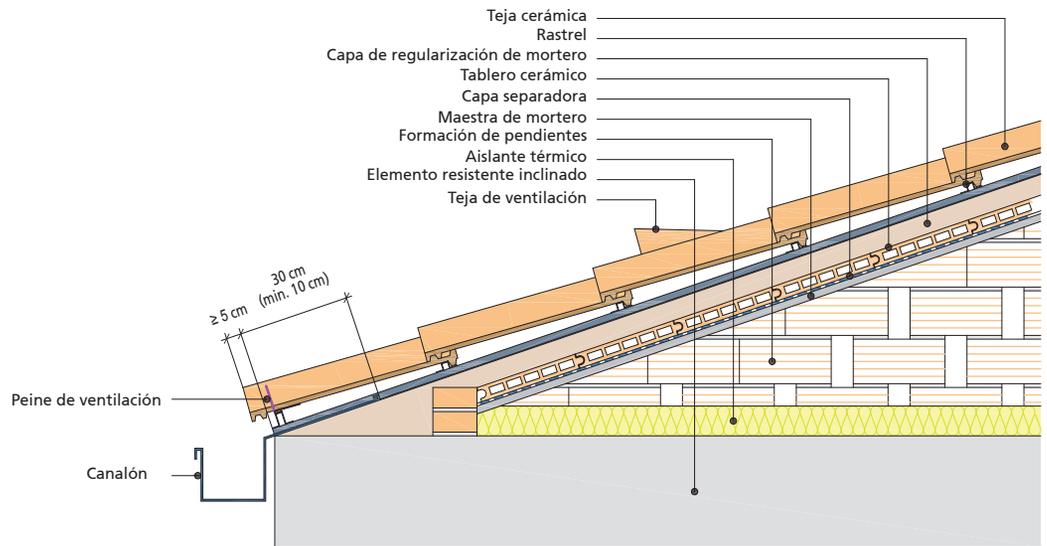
Cubierta inclinada de tablero cerámico sobre forjado
